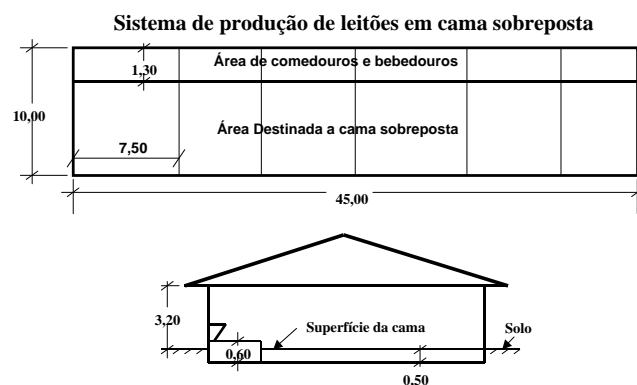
Planta baixa e cortes da unidade de produção de leitões, unidade de medidas (m).
